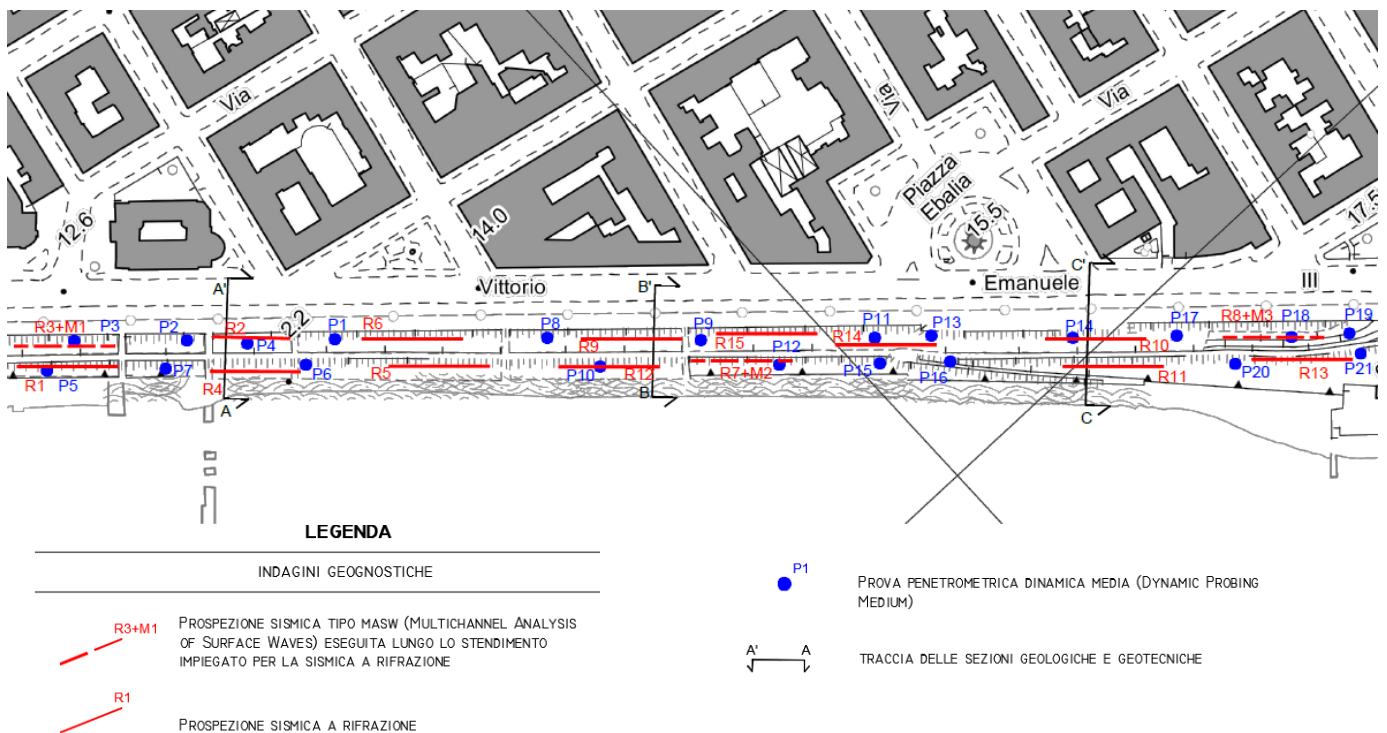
Stralcio planimetria ubicazione indagini su cui sono riportate le tracce delle sezioni geologiche e geotecniche per il presente progetto.
